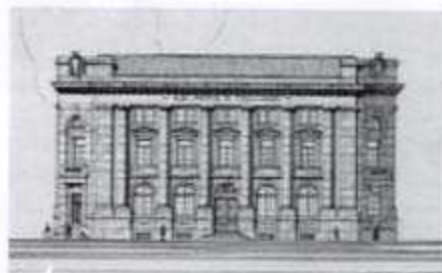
C. Bazzani, Pescara. Palazzo delle Poste. Progetto del fronte anteriore (ibidem).
